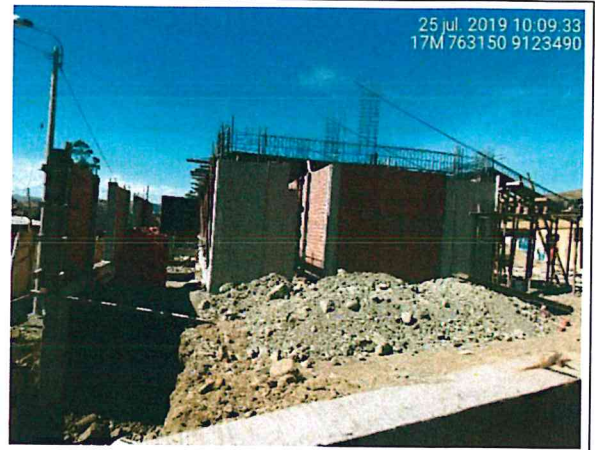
Colegio primaria en proceso de construcción con material de concreto.
